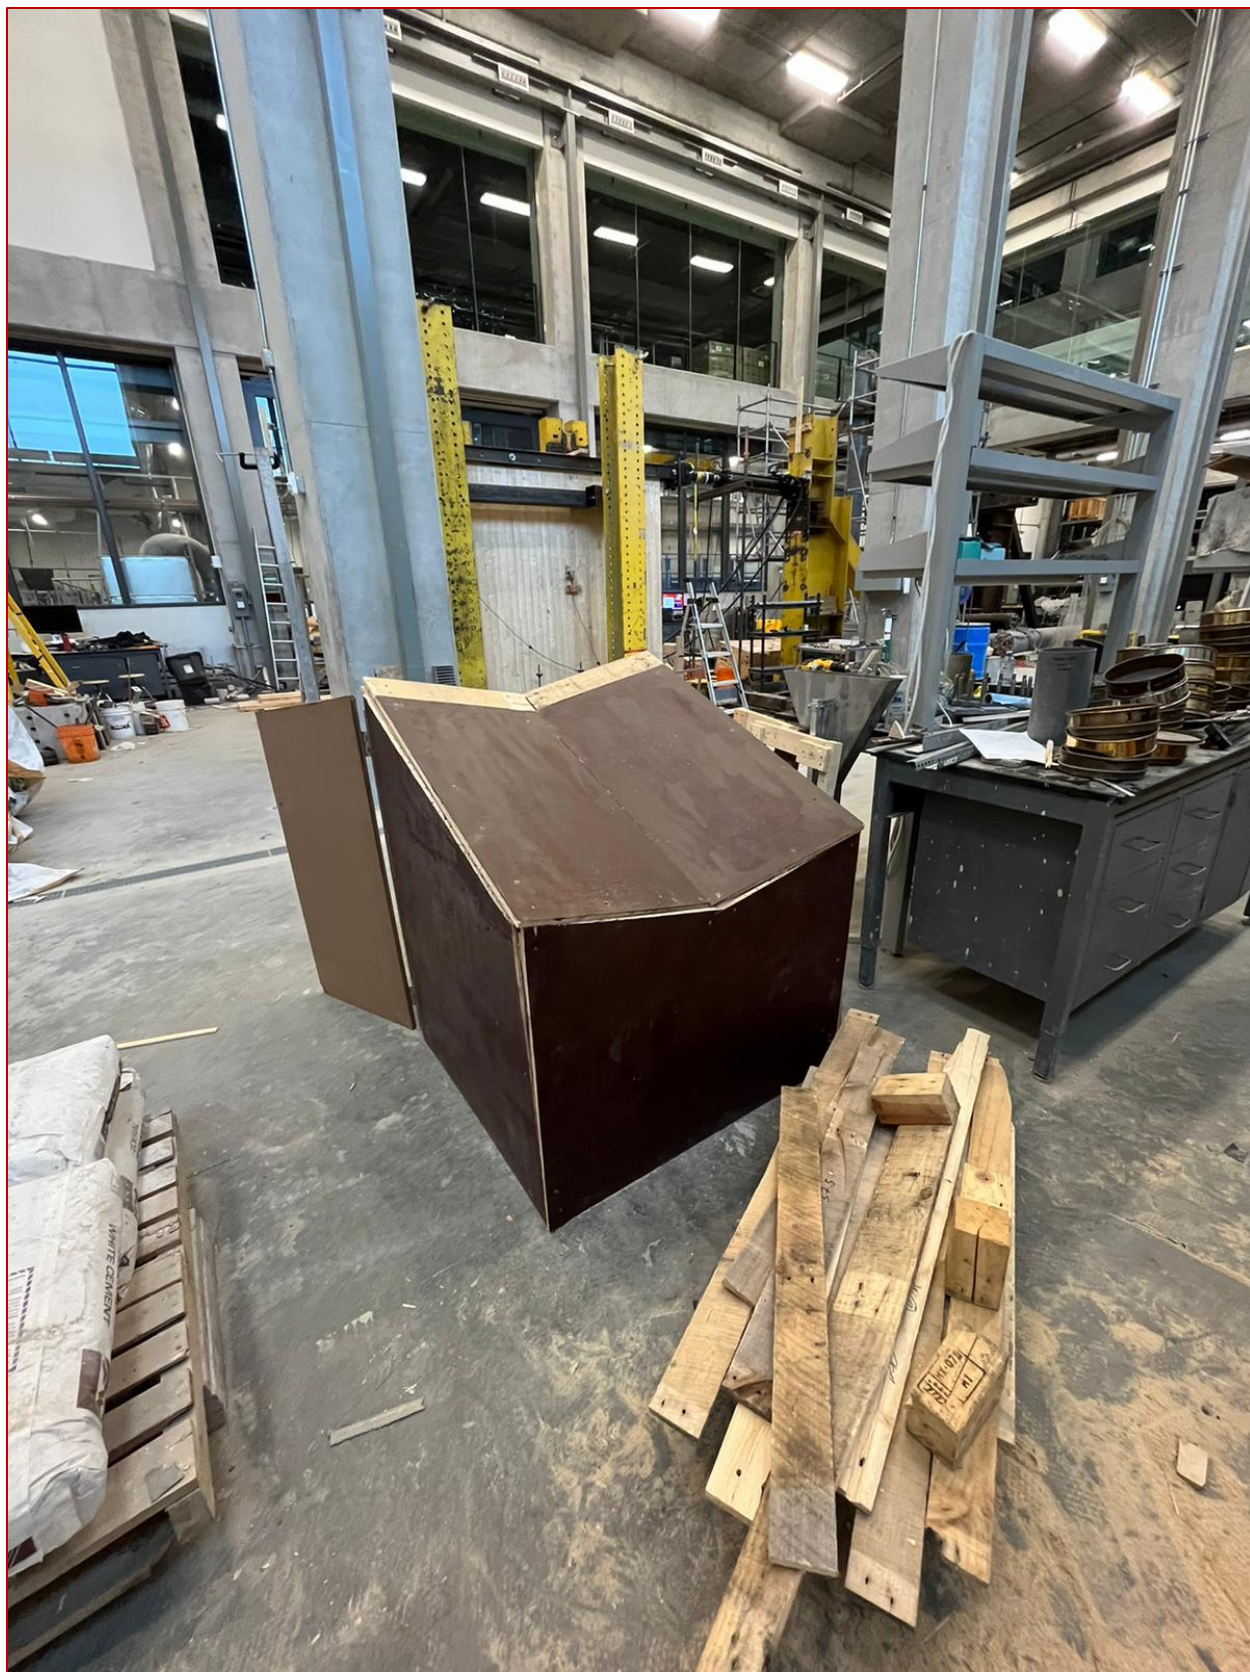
vue de l'arrière, au côté opposé des portes ouvertes
